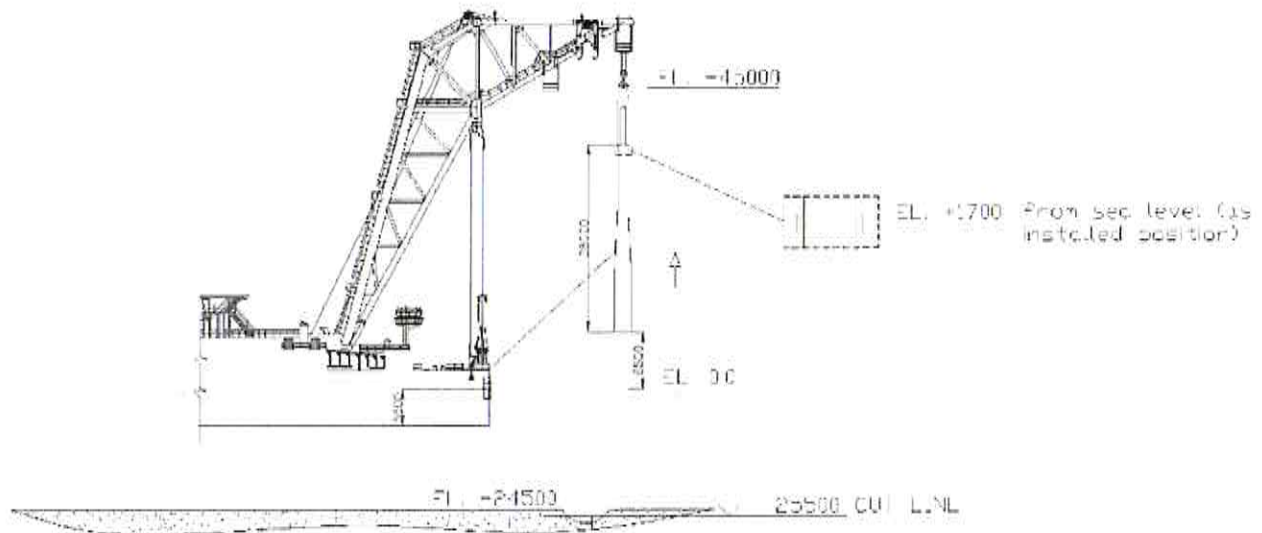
Monotubolare Ada 3 – Sketch di Rimozione tipico utilizzando Nave Gru a Braccio Fisso
